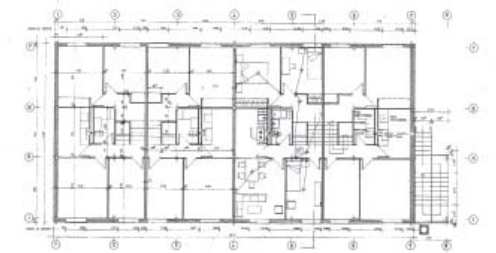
Planta general tipo de viviendas con galería posterior en el bloque II para el proyecto de junio de 1963, firmado por Aracil, Miquel y Viloria. Nótese que los dormitorios de la crujía superior abierta a norte quedarían debajo de la galería de acceso, abriendo las cocinas y los baños unas ventanas altas a los tenderos de la misma
